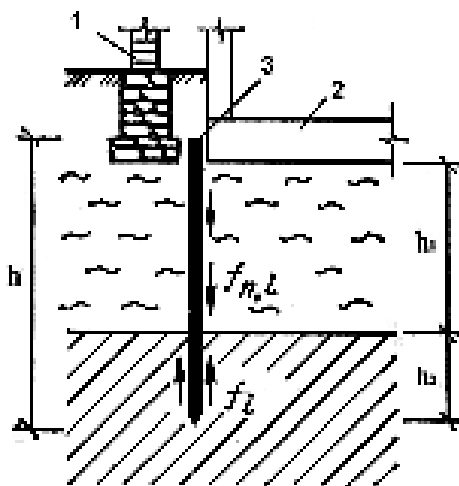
Разъединительная шпунтовая стенка: 1 – фундамент существующего здания; 2 – фундамент строящегося здания; 3 – разъединительный шпунт
